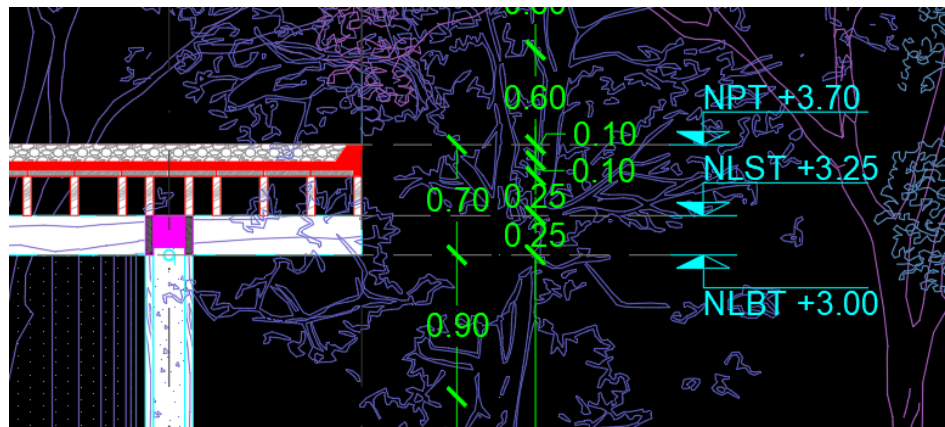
ESPESORES DE LOSA SOBRE PLANTA BAJA
